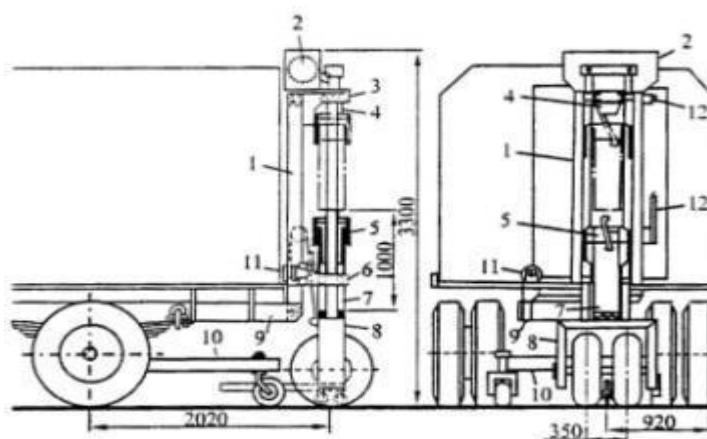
Установка для динамического нагружения (навесная УДН-НК): 1 - несущая рама; 2 - электроталь; 3 - верхний кронштейн; 4 - ограничитель подъёма; 5 - зацепное устройство; 6 - нижний кронштейн; 7- испытательный груз; 8 - штамп; 9 - опорная рама; 10 - измерительная тележка; 11 - лебёдка для подъёма штампа; 12 - прибор управления электроталью
